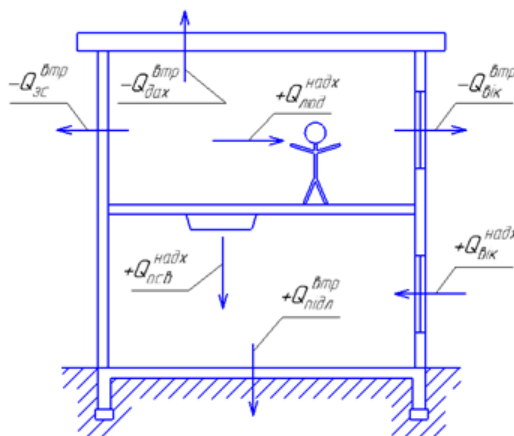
Розрахункова схема теплообміну будівлі
